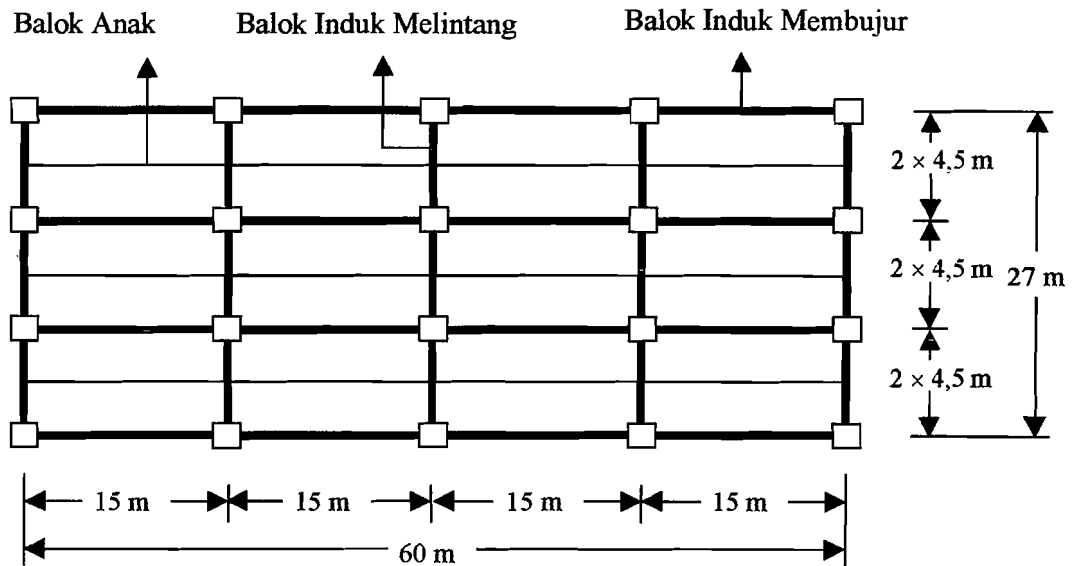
Denah Penempatan Balok Anak Tipe B
